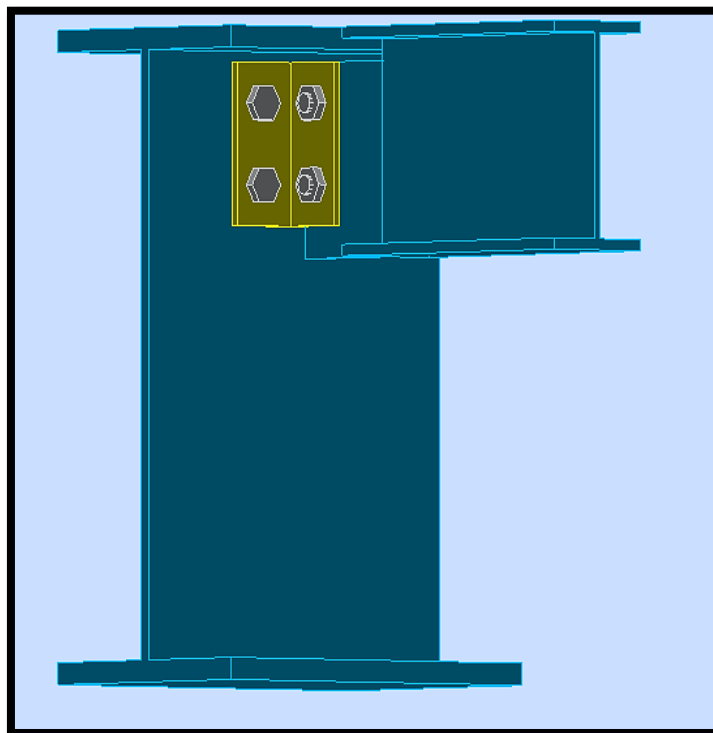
Vue en 3D de l'assemblage poutre-solive.
